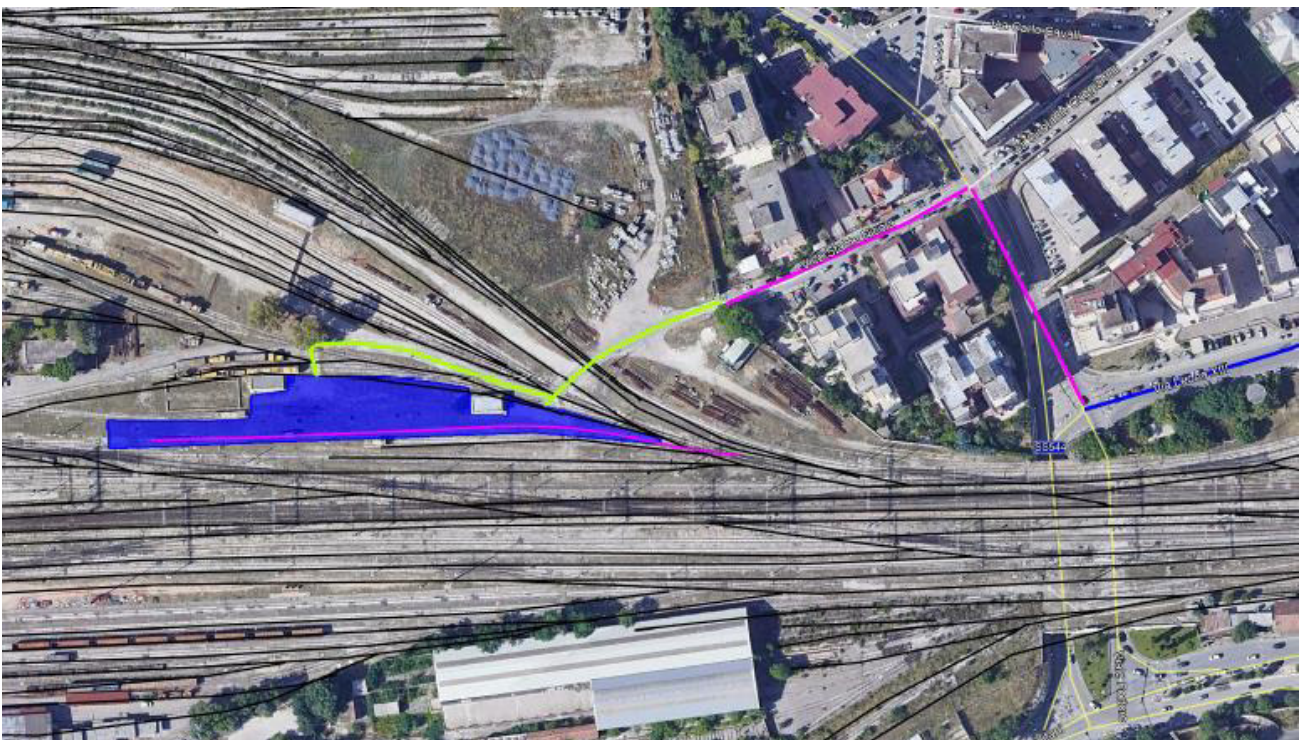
Vista aerea dell'area destinata al Cantiere Armamento e Tronchino (ortofoto aggiornata 2019)
